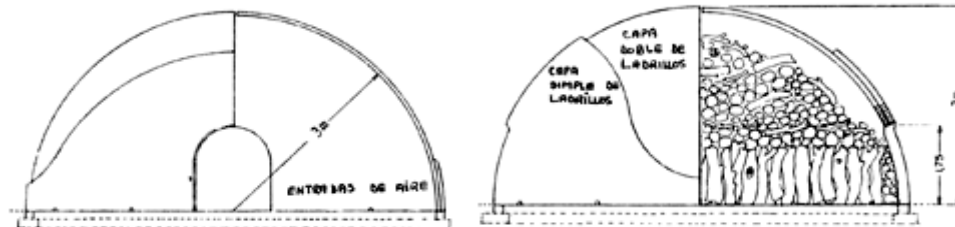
El horno es semiesférico, con dos puertas opuestas para facilitar la carga y descarga y para ventilar.
